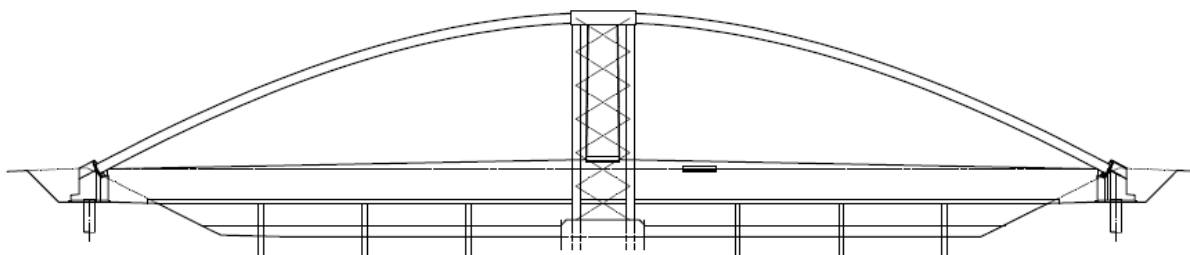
Vybetonování pilot a základů integrovaných opěr.
